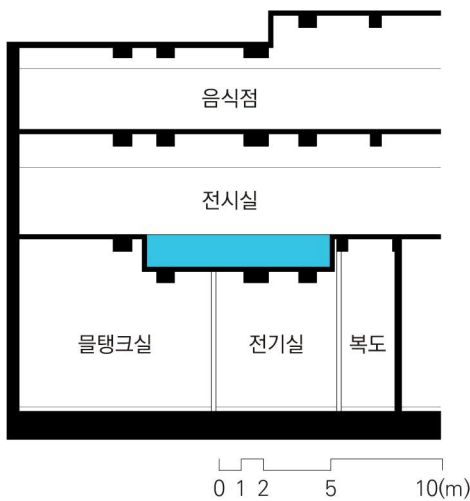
<파고다타워> 바닥 유리각 방식 단면도 (출처: <파고다타워> 심의자료, 저자편집)
